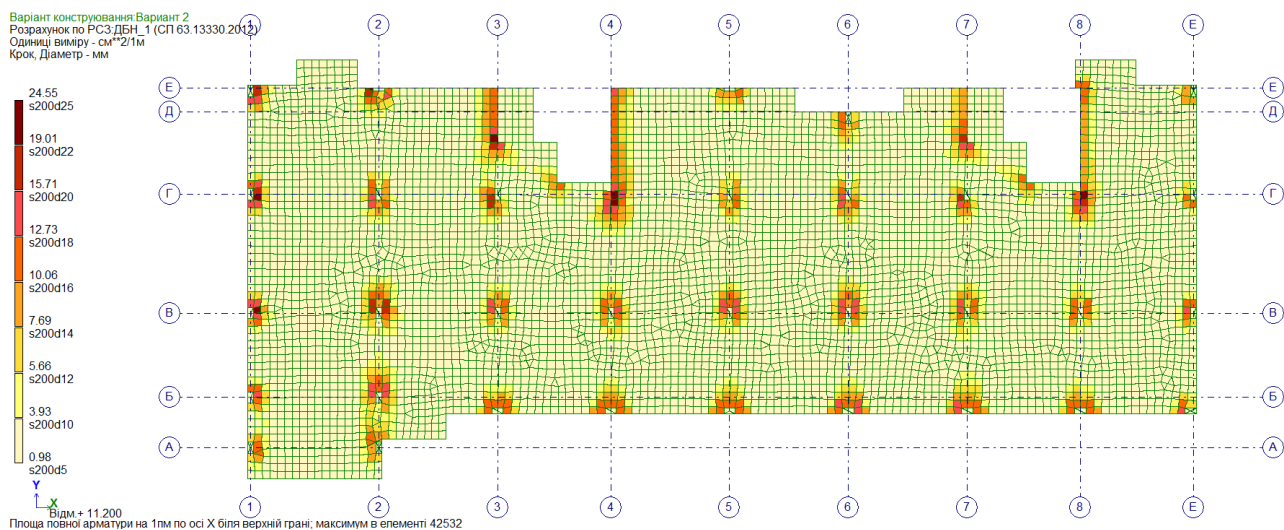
Ізополя розрахункового армування плити перекриття типового поверху. Верхня арматура вздовж осі X
